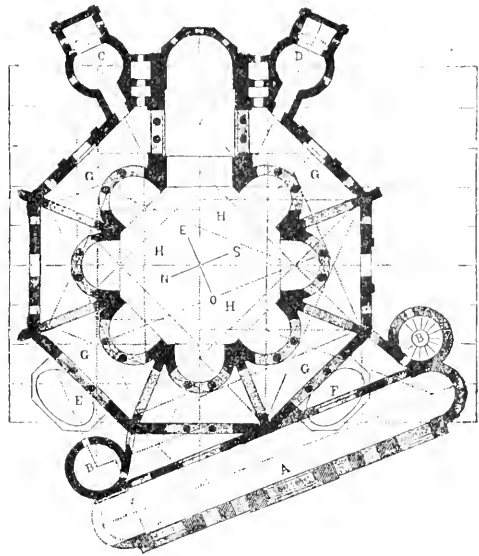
Grundriss von S. Vitale zu Ravenna.
